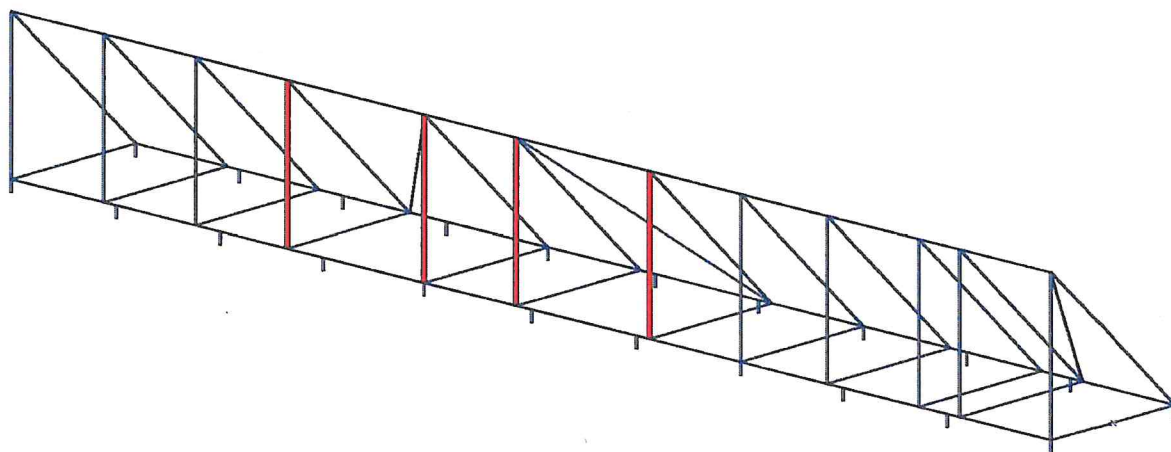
Doplnění základající podstavy o jackl TR40/4
